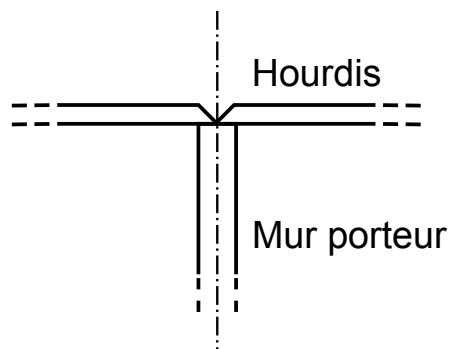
On considère les planchers appuyés sur la mi-épaisseur du mur sur lequel ils sont posés.
